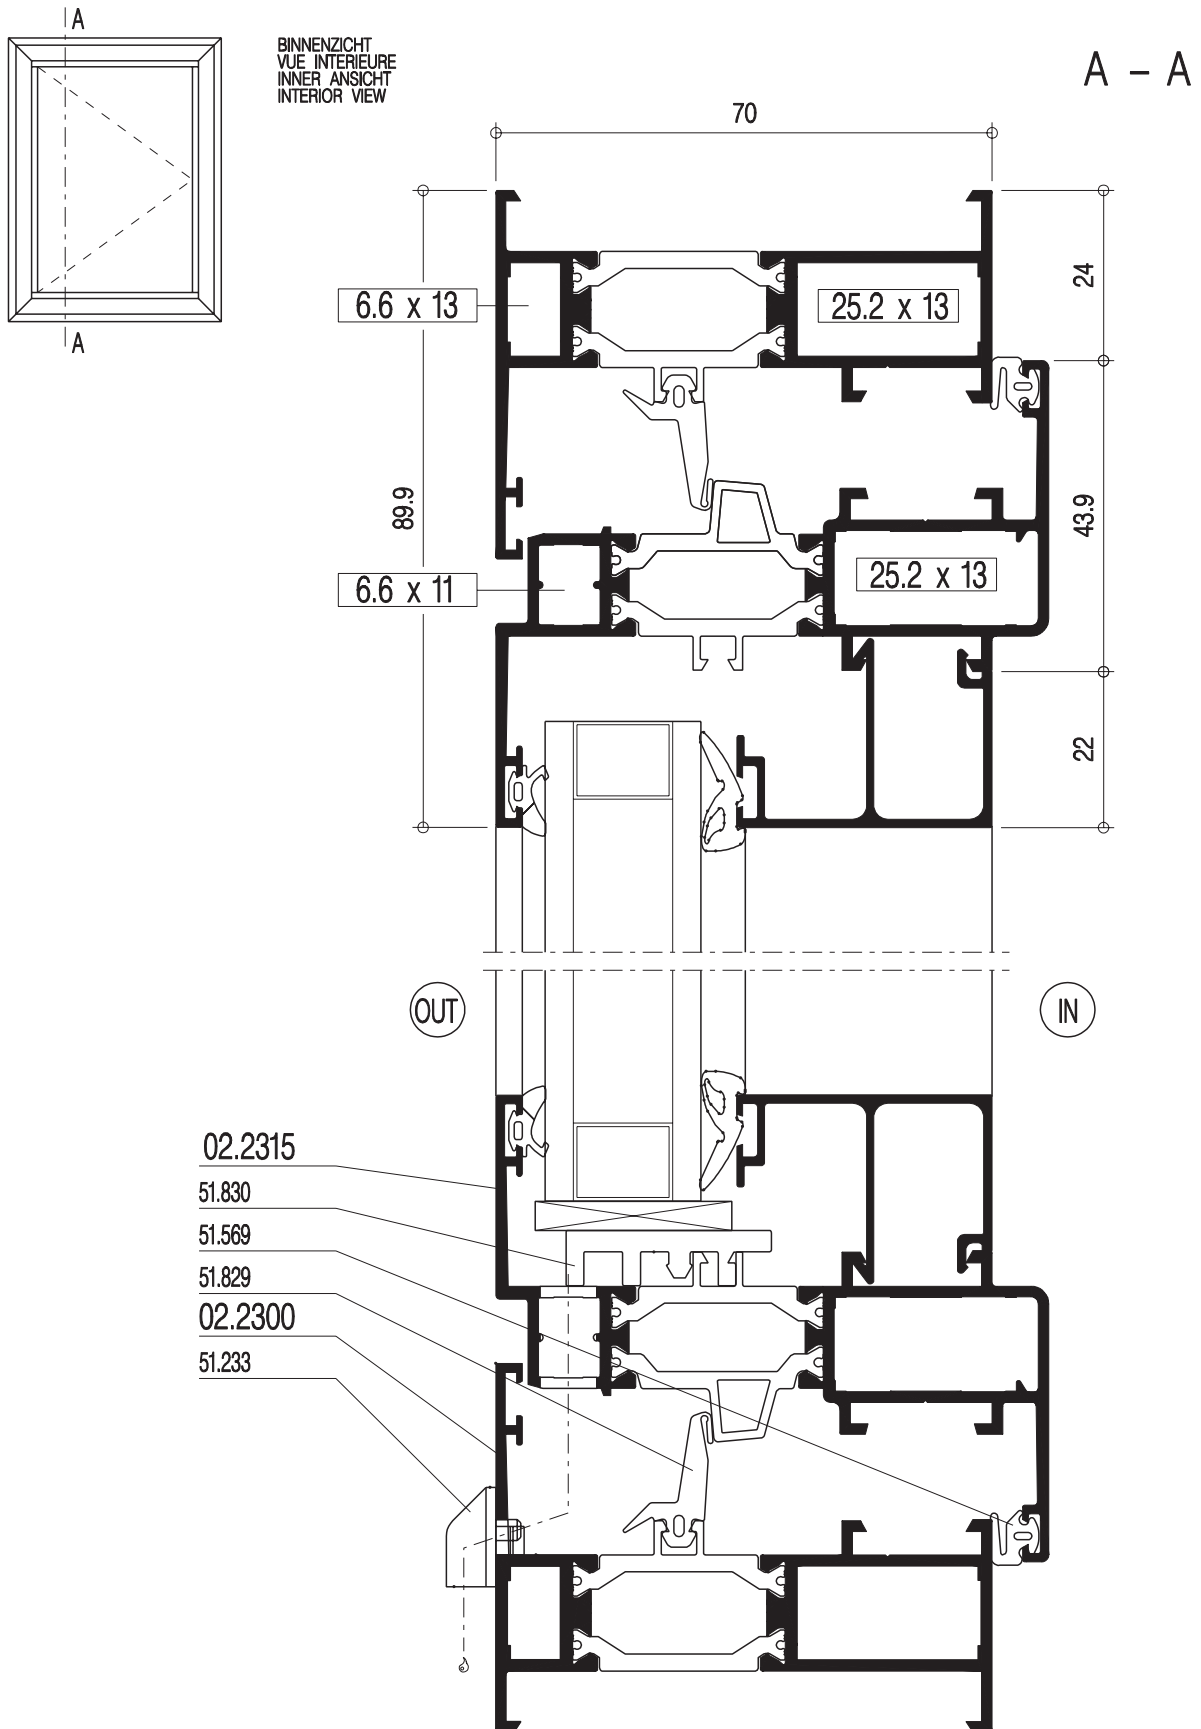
Snede door opengaand raam - Coupe dans fenêtre ouvrante
